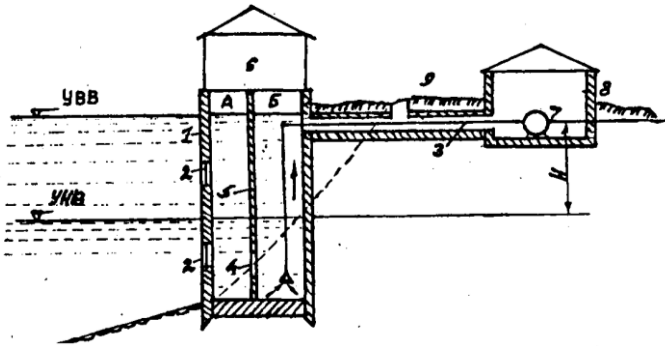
Раздельный водоприемник берегового типа: А – водопроводное отделение; Б – всасывающее отделение; 1 – водоприемный колодец; 2 – водоприемные окна; 3 – всасывающие трубы; 4 – сетки; 5 – перегородка; 6 – служебный павильон; 7 – насосы; 8 – насосная станция; 9 – галерея.
